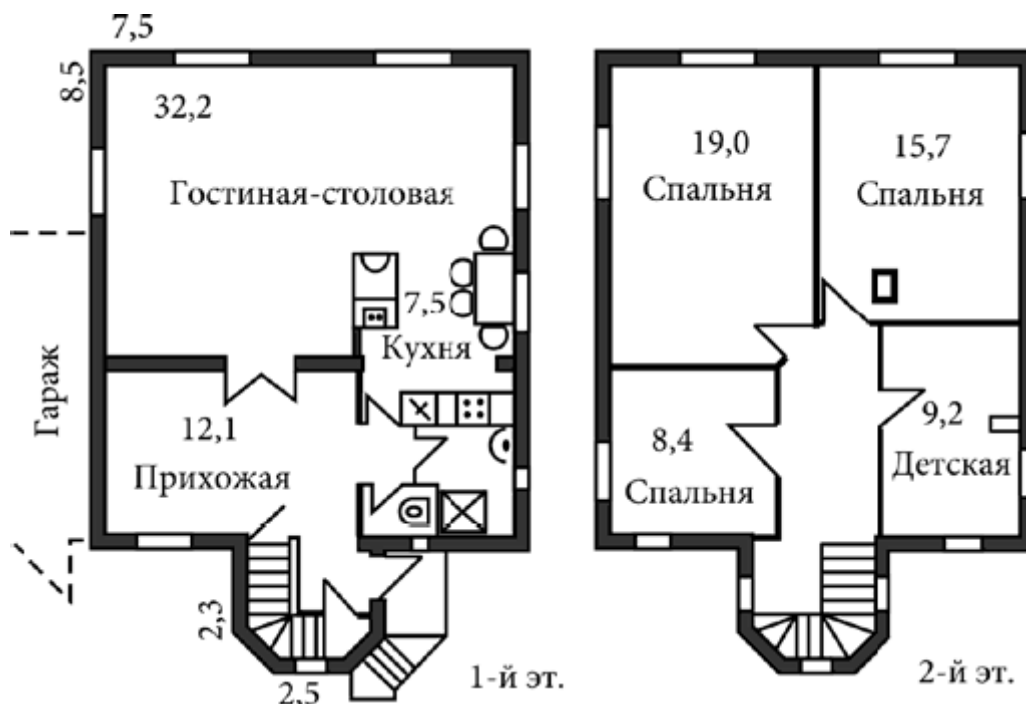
Планировка дома с зимним отоплением только первого этажа (вариант 1)
